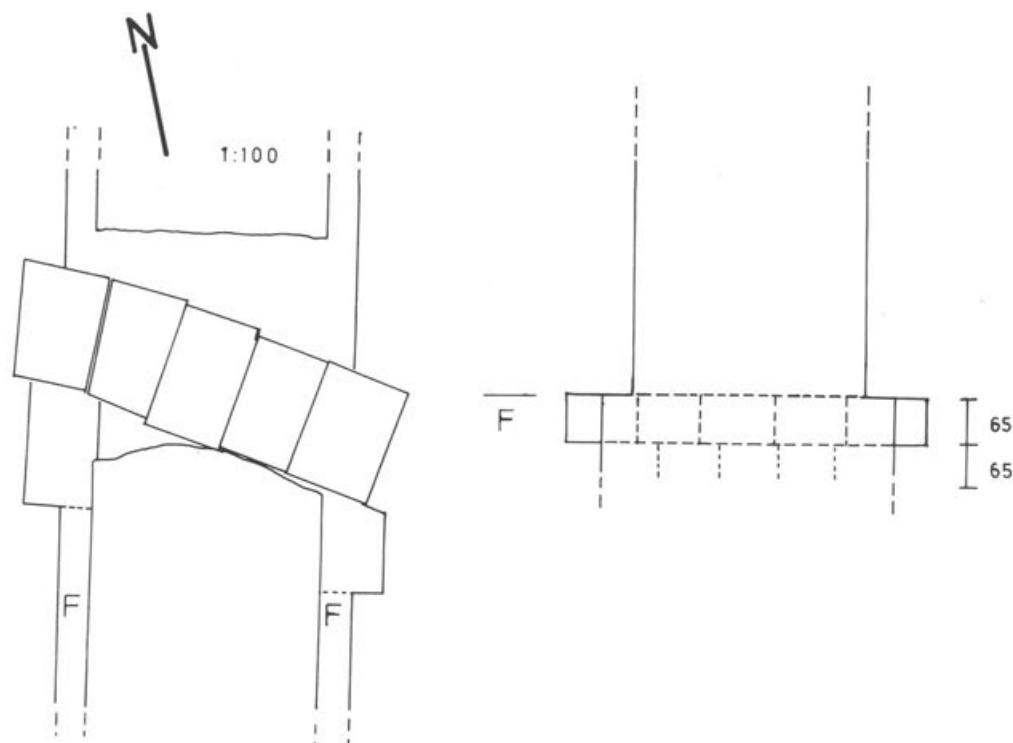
Plan et coupe des pierres de taille dans les substructions de la muraille au Sud de l'Amphithéâtre, dans la vallée de l'Olewigerbach. (Redessiné d'après Lehner, Wdz, 15, 1896, Tav. 4-5, fig. 7-8).
